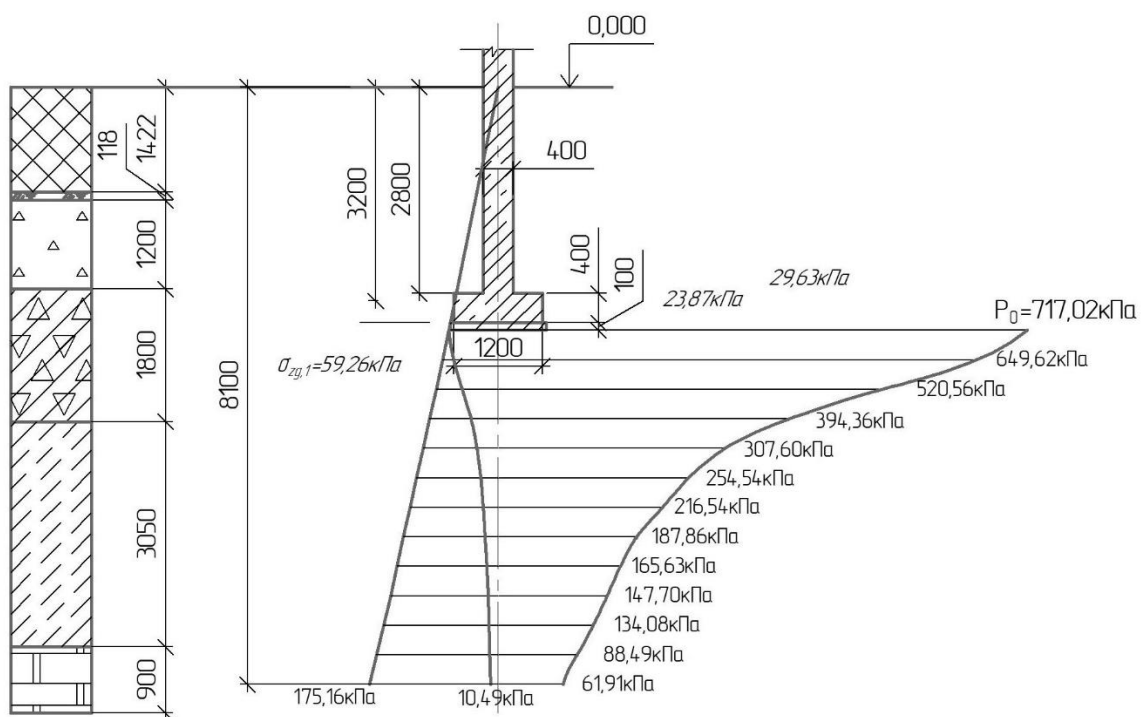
Схема расчета осадки ленточного фундамента
